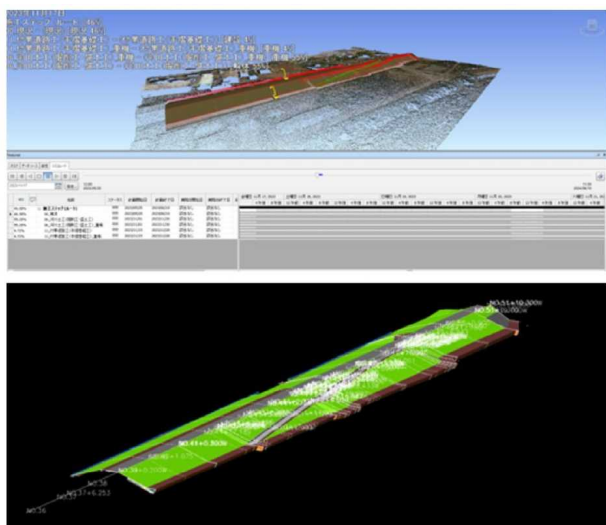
(参考画像)BIM/CIMモデルを活用した施工ステップの確認
